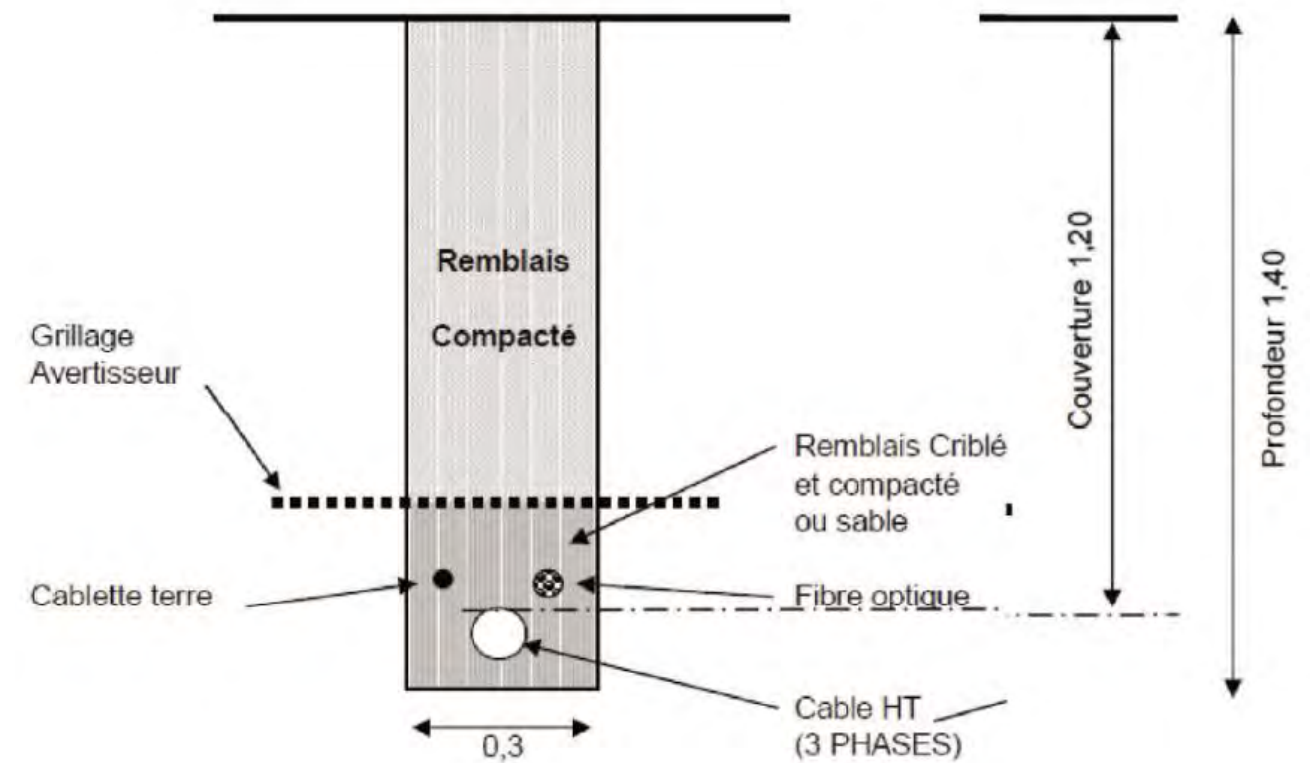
Coupe type d'une tranchée accueillant le câblage (Source : BE Jacquel et Chatillon)
